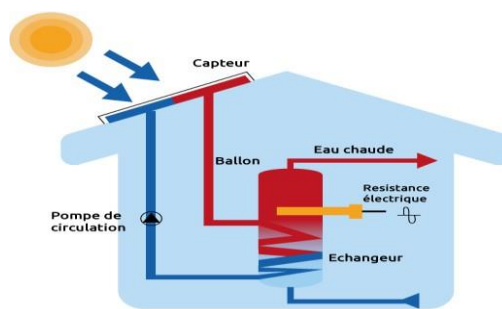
schéma d'une installation d'un chauffage solaire
